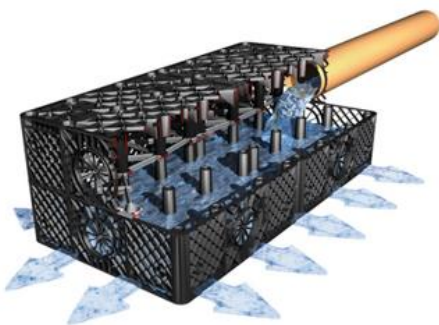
Sademevee immutusblokk ([Puhastid.ee](#))
